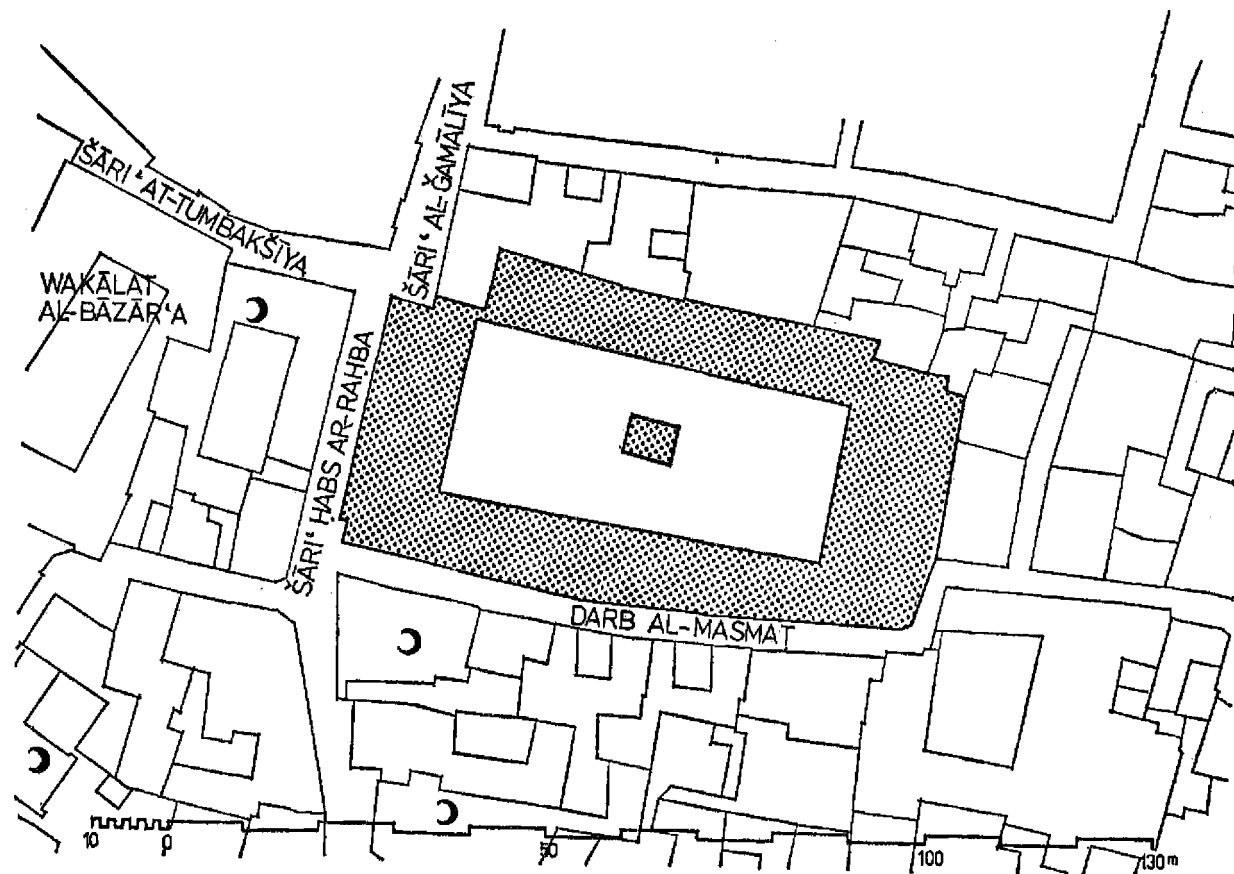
Kairo, Wakalat Du l-Fiqar, Lageplan
